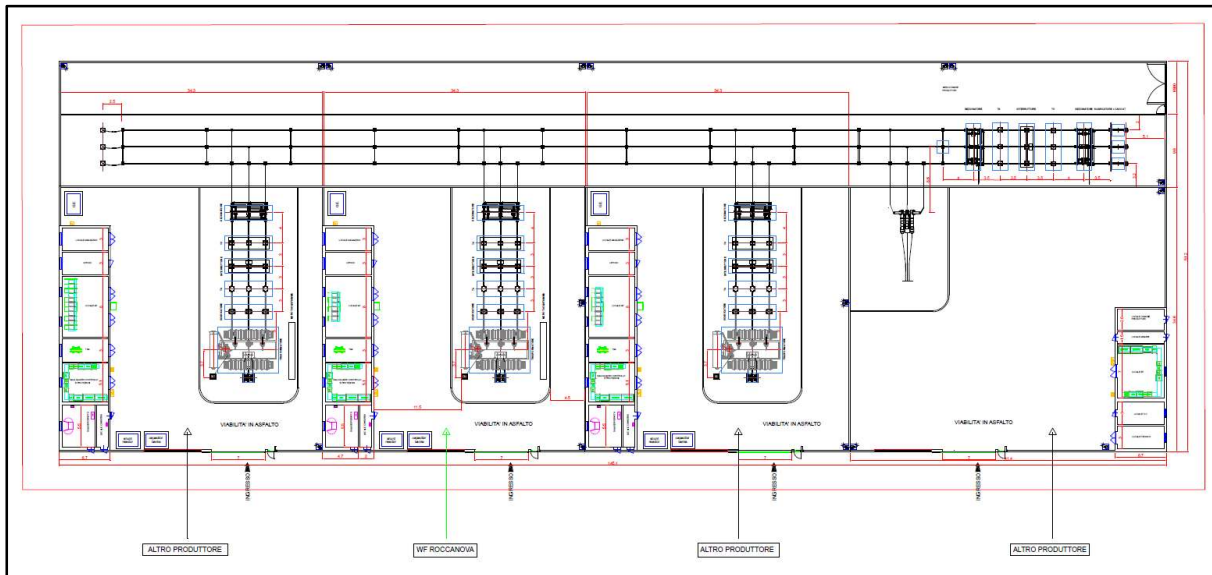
Planimetria elettromeccanica della sottostazione elettrica condivisa
